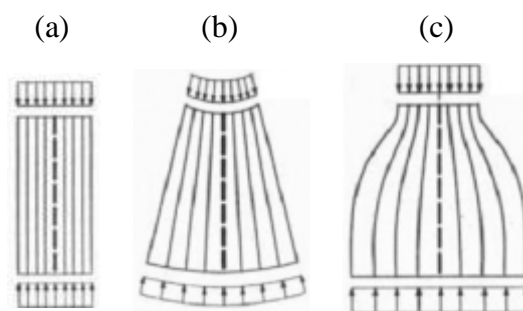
Tipos de bielas (a) prismática, (b) em leque e (c) em forma de garrafa (SCHLAICH *et al.*, 1987).
